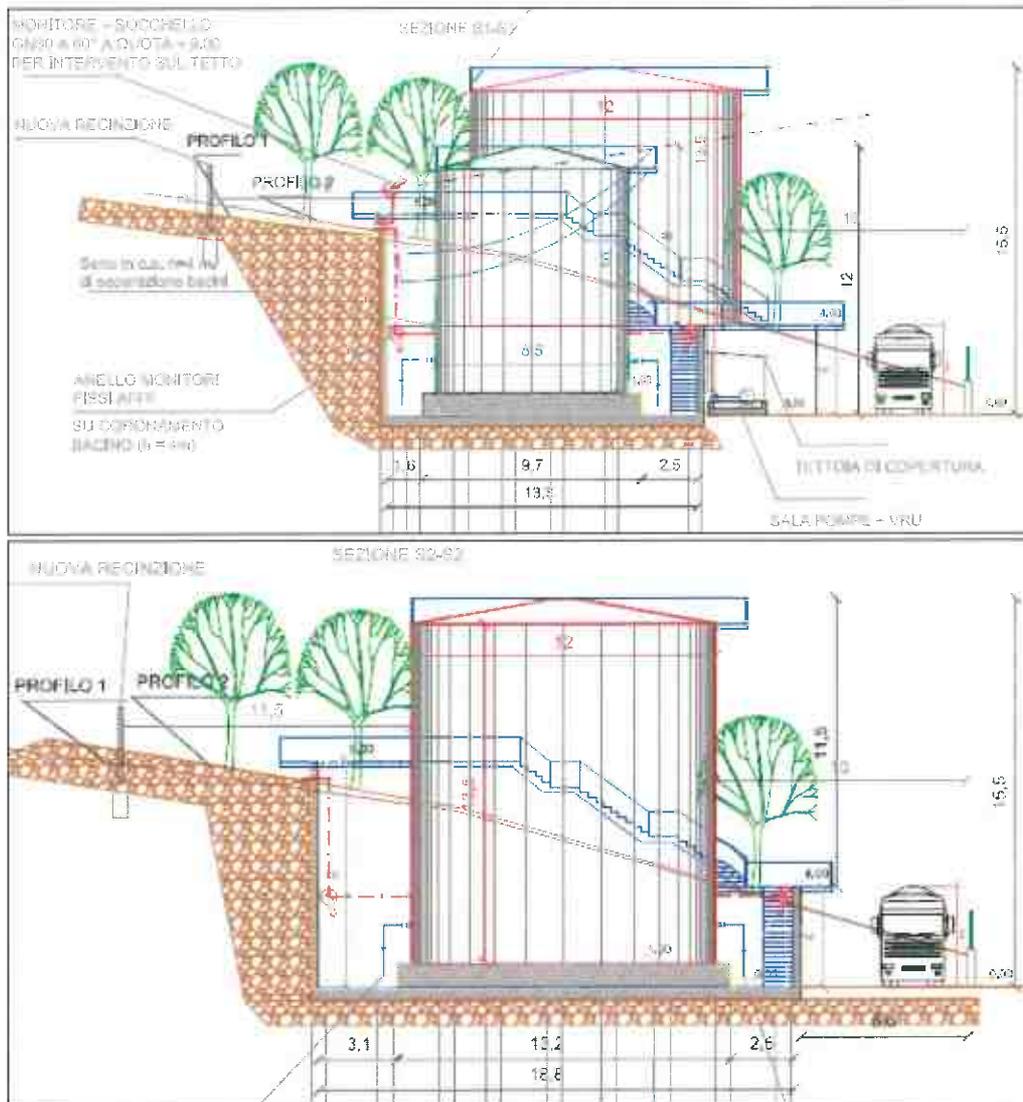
Sezioni di progetto (da Elab. T9 allegato allo SPA)
